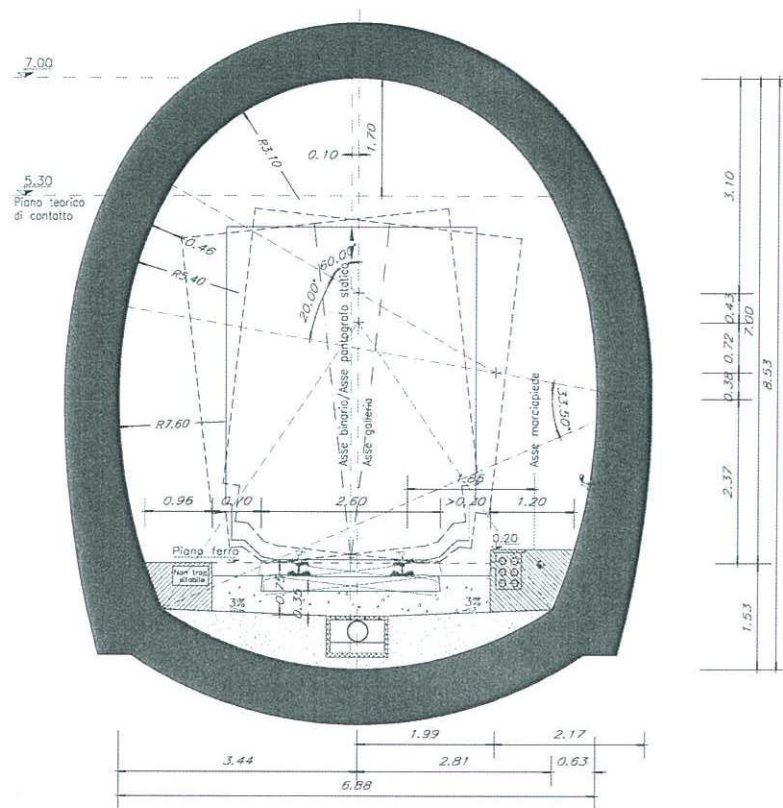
Sezione tipo di ntrado sso galleria semplice binario scavo tradizionale
